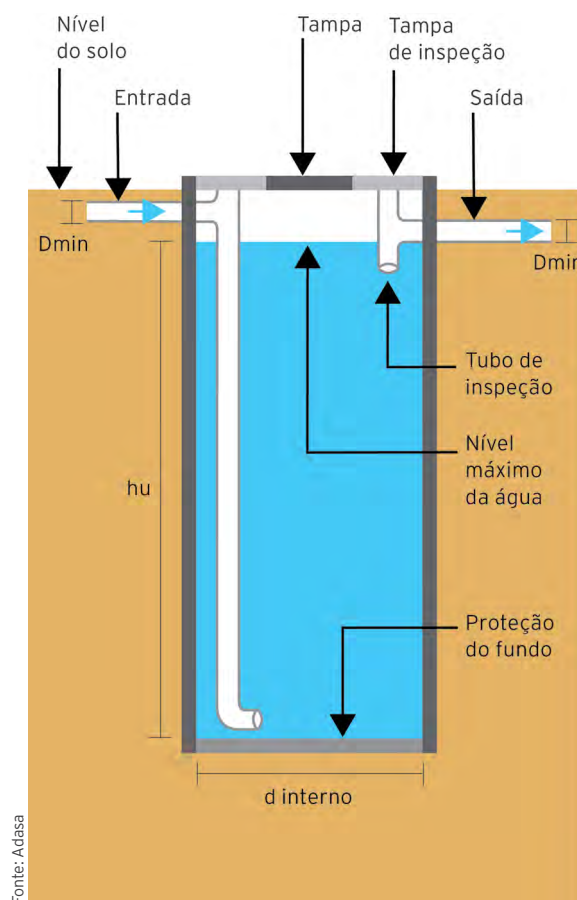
Poço de Infiltração sem Preenchimento - Corte Lateral.
